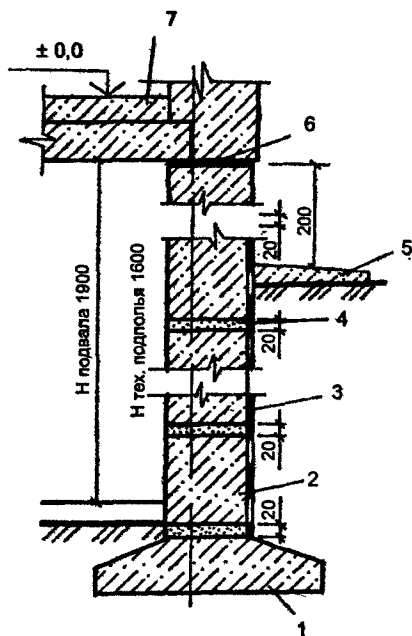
Сборный ленточный фундамент из бетонных блоков под стены дома с подвалом и техническим подпольем:
